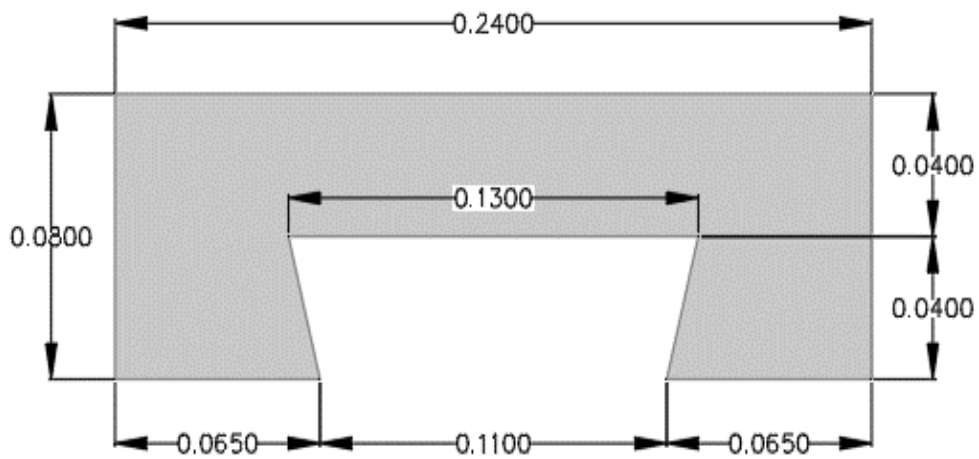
Vista en planta de las dimensiones del bloque tipo I.
